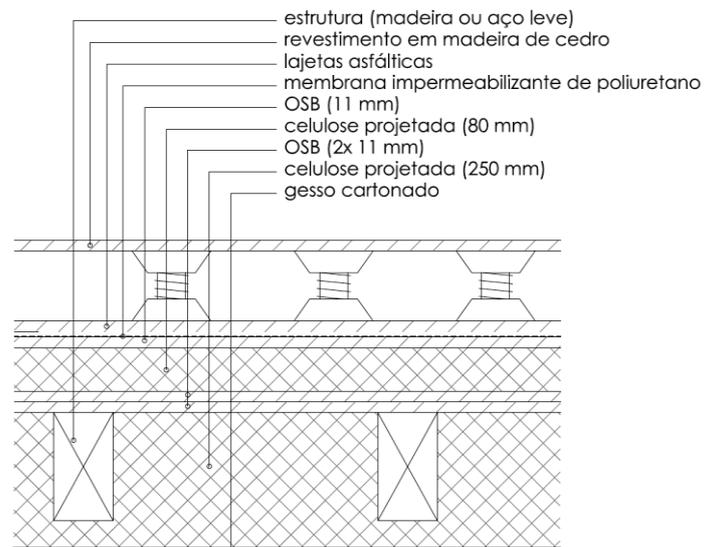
Laje de cobertura em terraço (sem escala)
